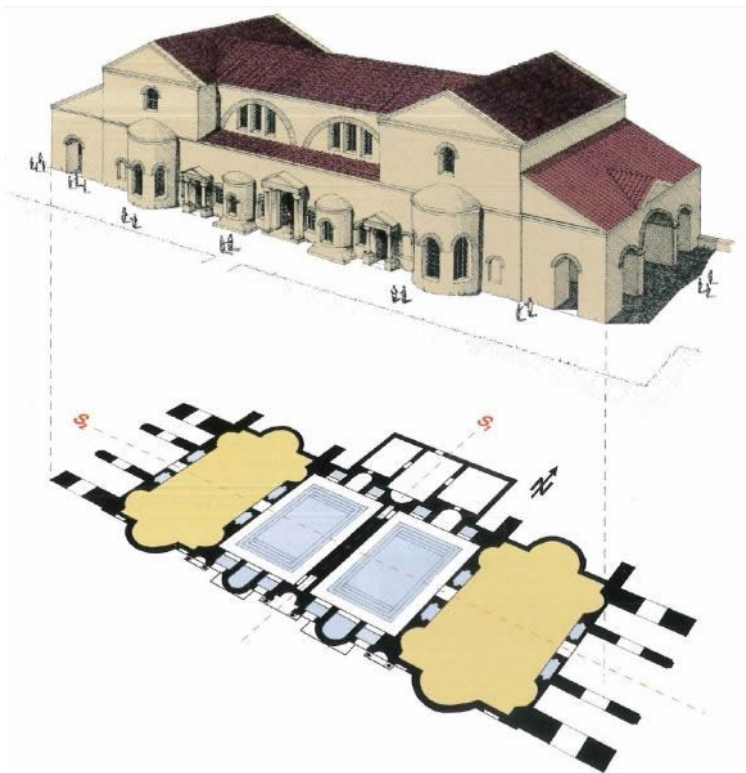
Stabilimento termale, Fase 1. Planimetria e ricostruzione. Fonte: Filgis 2002 p. 61 fig. 37.
